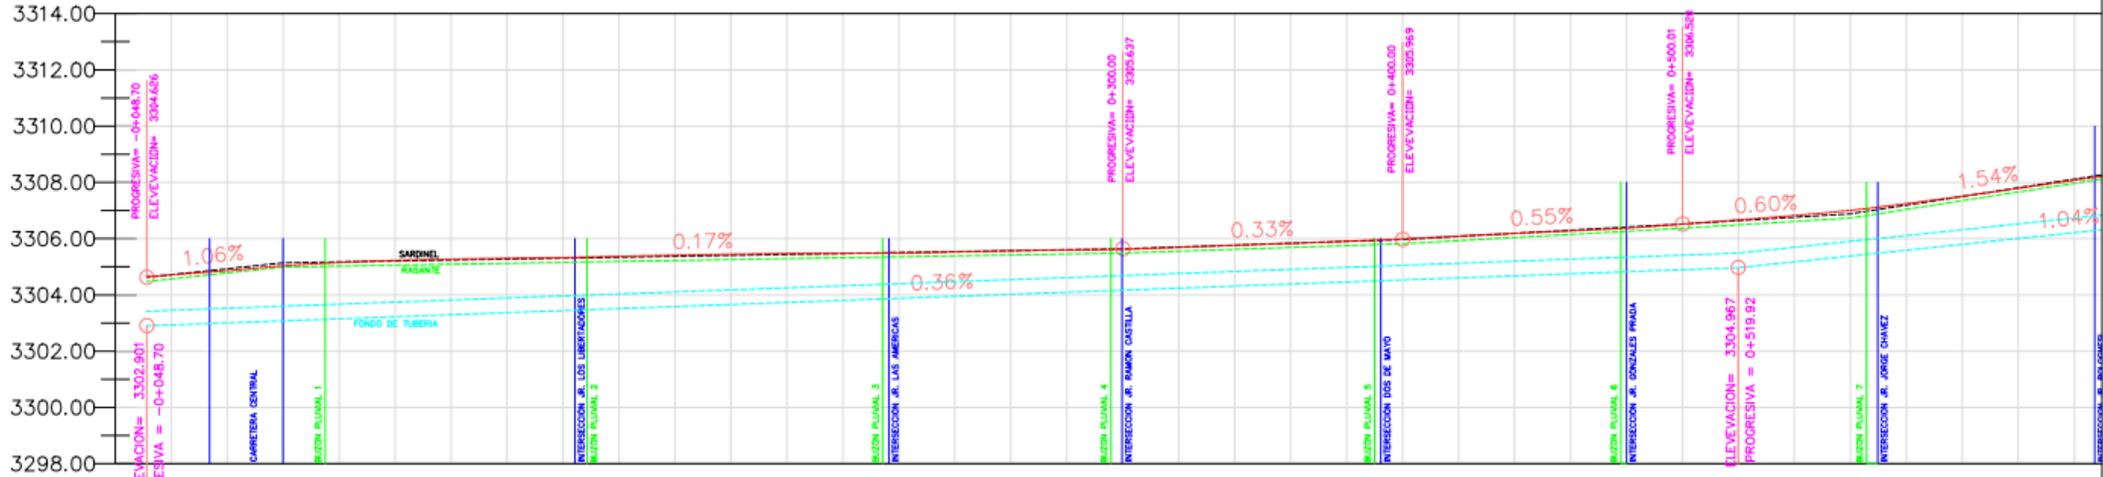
Planos Del Perfil Longitudinal De Desague Pluvial
